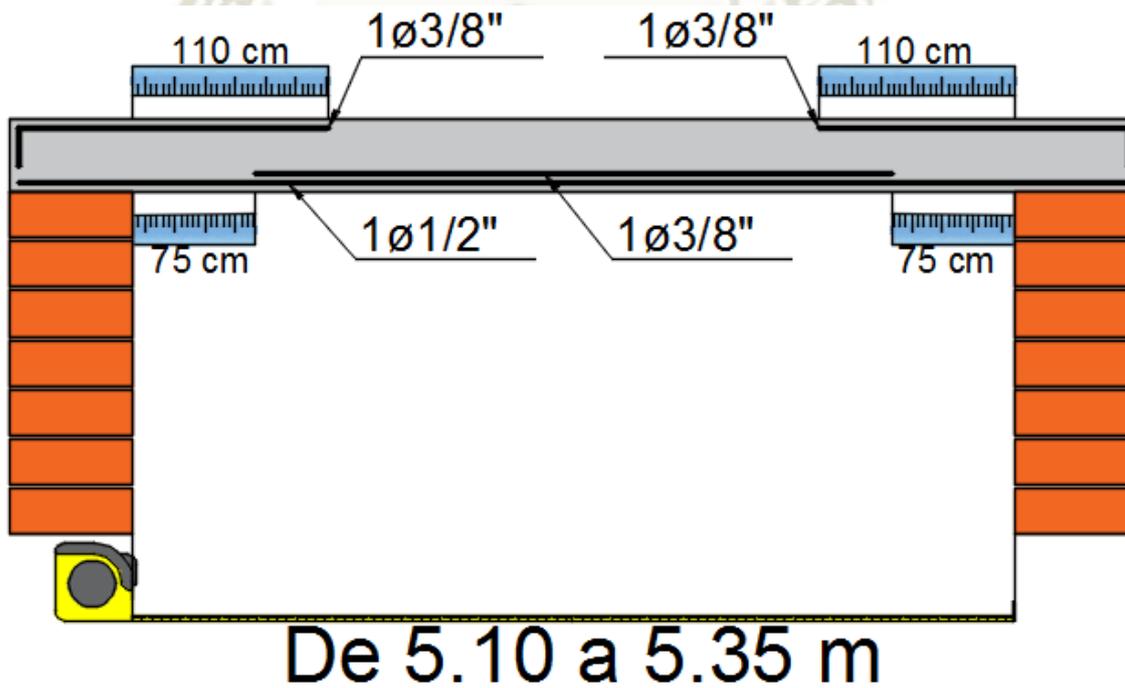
Refuerzo de vigueta hasta 5.35 m.
